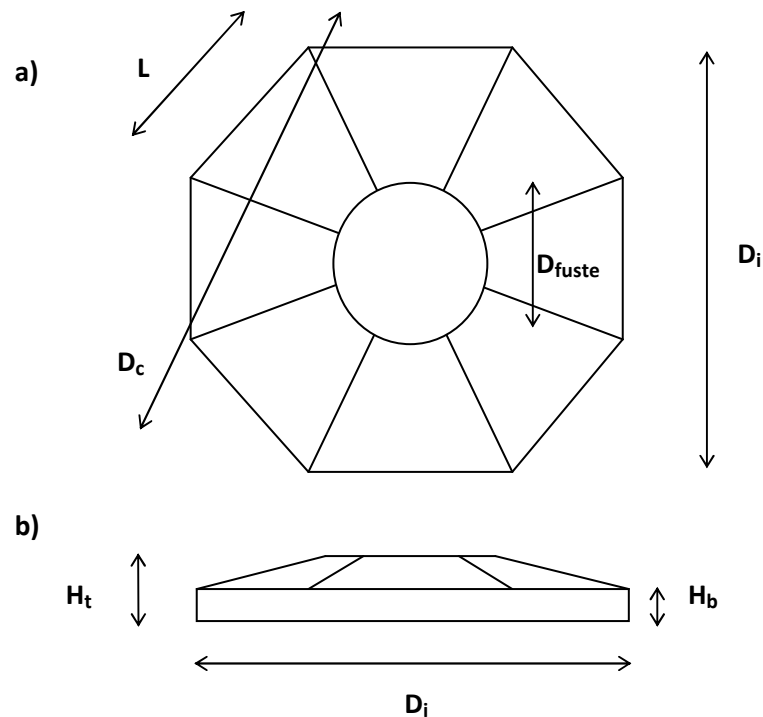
Zapata octogonal: a) vista en planta, b) vista en alzado.
